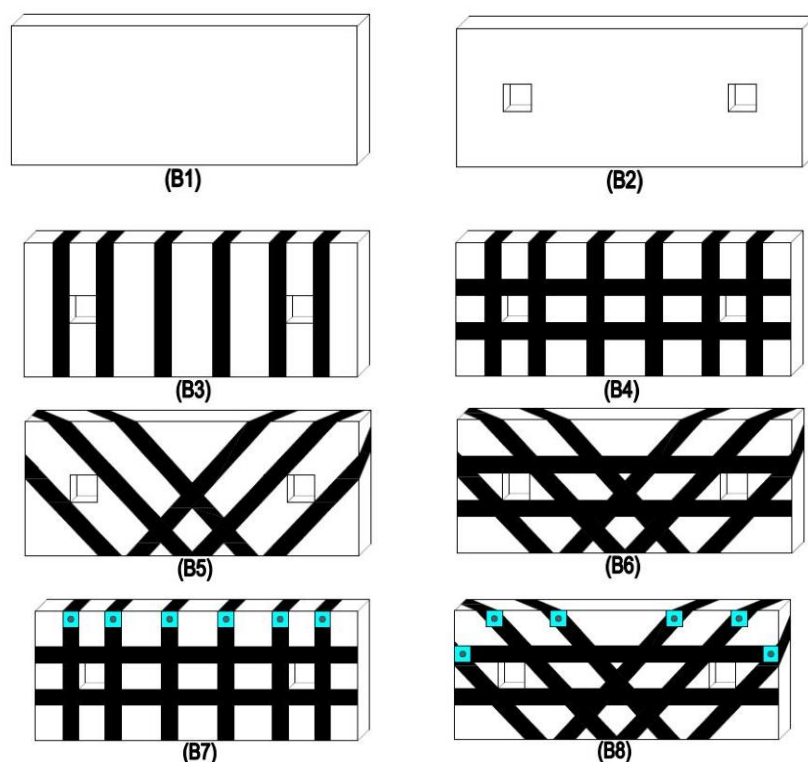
Detalhamento do reforço das vigas-parede (ABDULJALIL, 2014).
